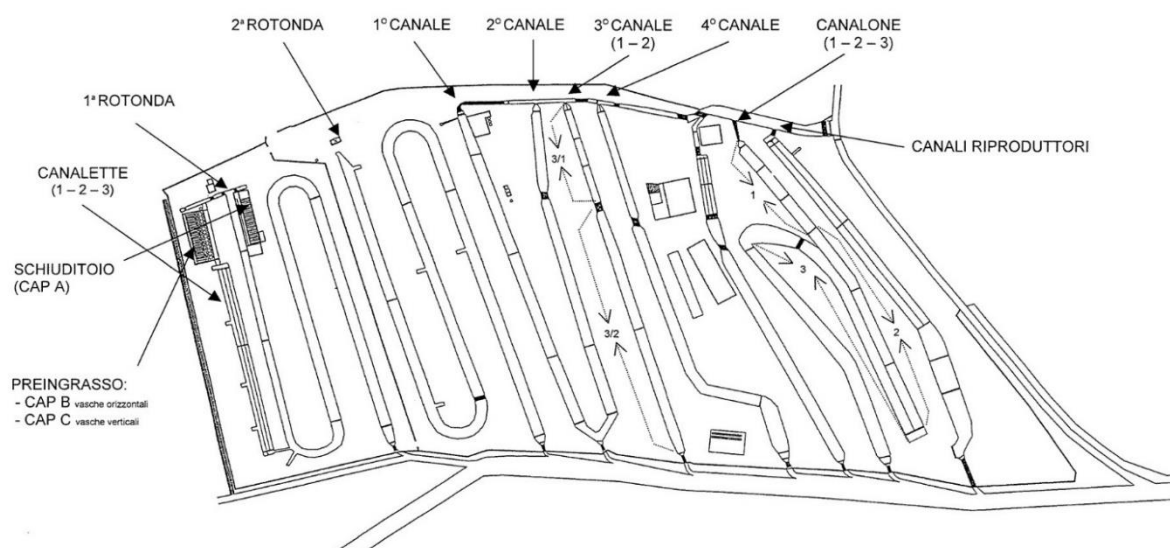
Planimetria dell'allevamento convenzionale di Istrana (TV).
